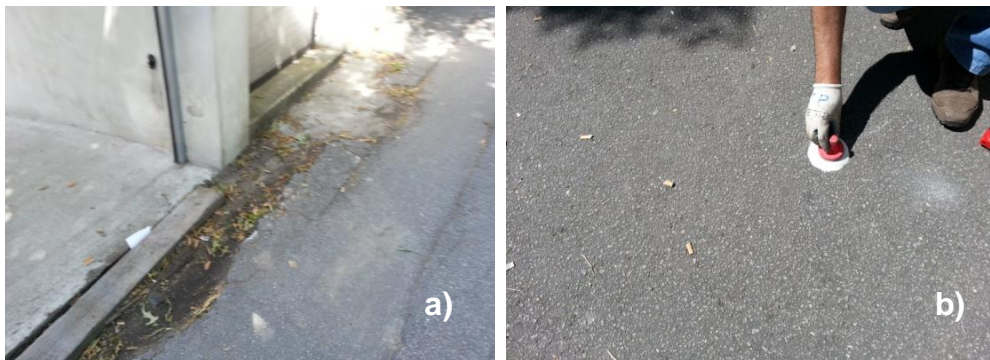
a) Condições heterogéneas de pavimentação; b) Ensaio da mancha de areia em pavimento betuminoso (Braga)
